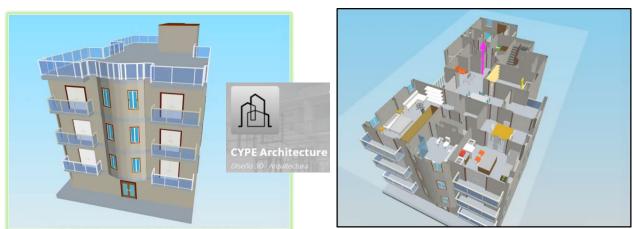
Modelado Arquitectónico Open BIM (CYPE Arquitectura).
